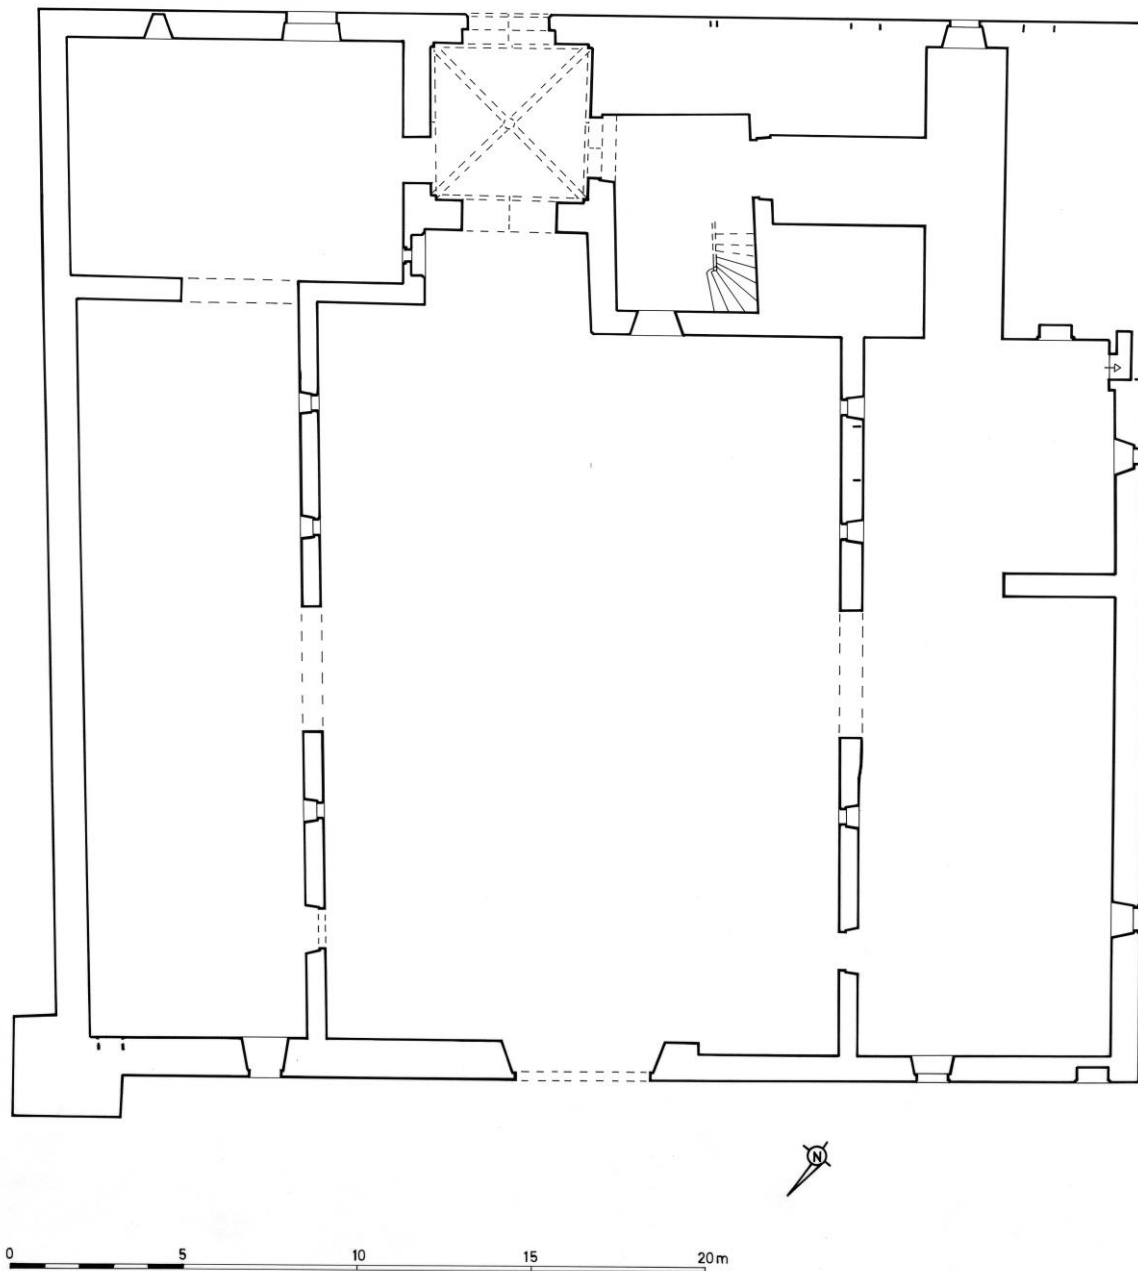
Relevé du plan du château par Patrick Roques (1997) : rez-de-chaussée.
